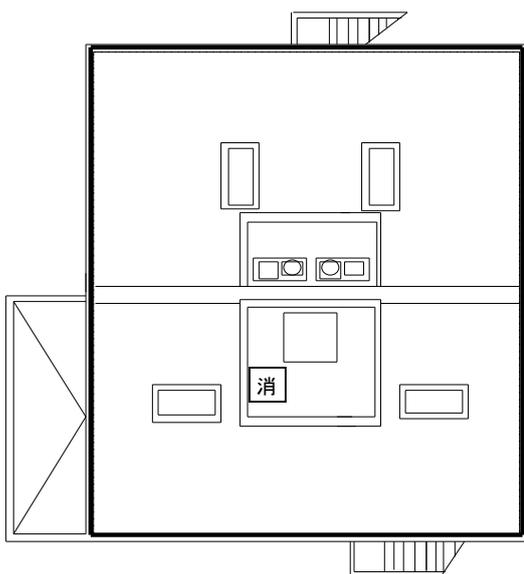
廃液貯留施設Ⅱ 保管廃棄設備配置図
